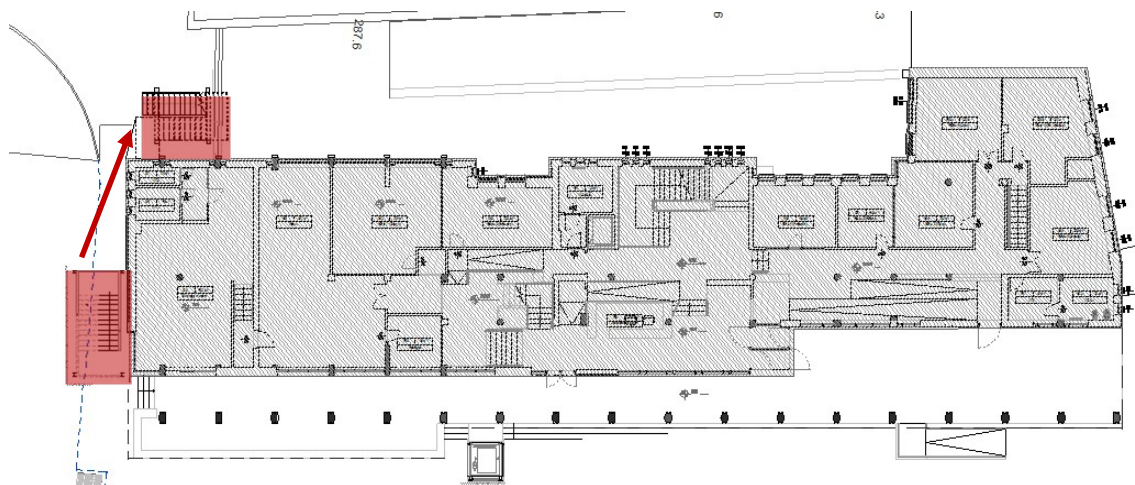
Pianta piano terreno - Posizione alternativa scala di esodo esterna
